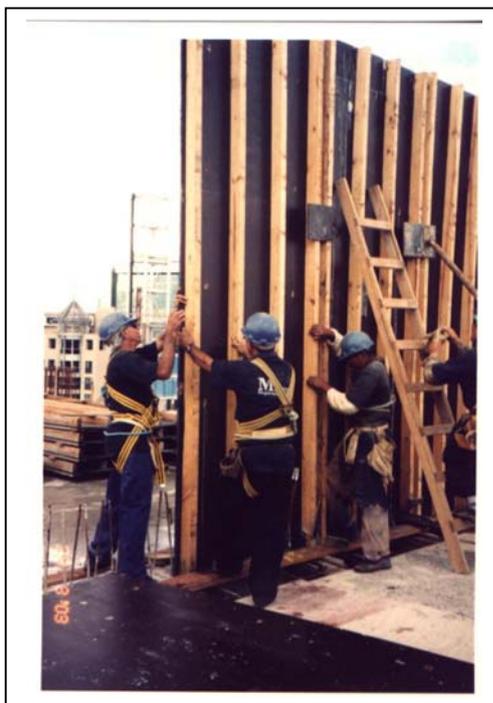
Montagem dos Painéis dos Pilares do Núcleo
